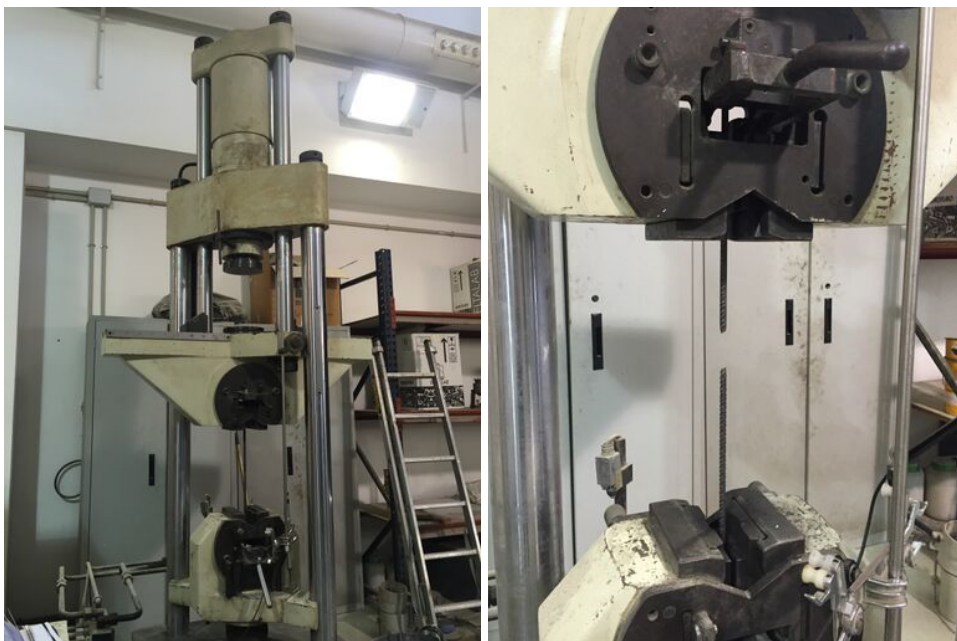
Ensayo de tracción de las barras de acero corrugado: a) Vista general del ensayo; b) Barra corrugada tras la rotura
